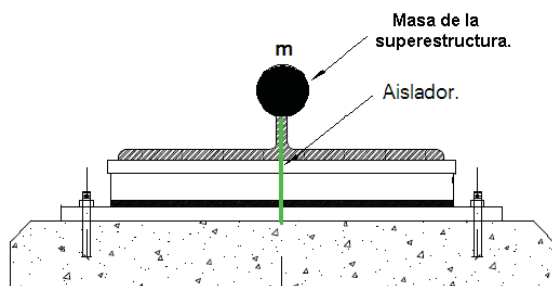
Consideración sobre la masa de la superestructura para el modelo inelástico.
